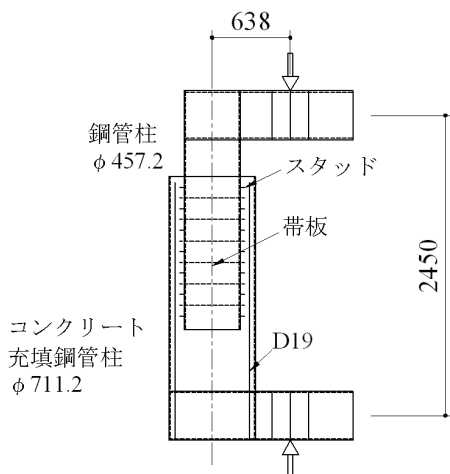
コンクリート充填差し込み継ぎ手試験体⁵⁰⁾ (単位 mm)
